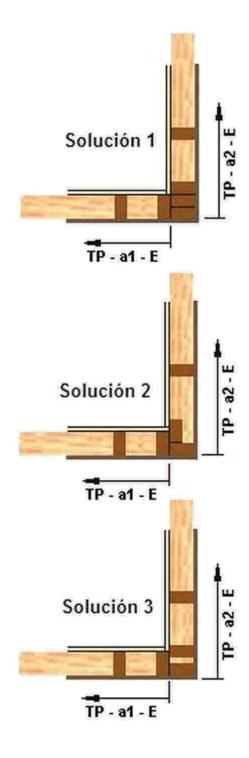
57: Vista en planta de soluciones 1,2 y 3 para el encuentro de muros y / o tabiques en ángulo.
